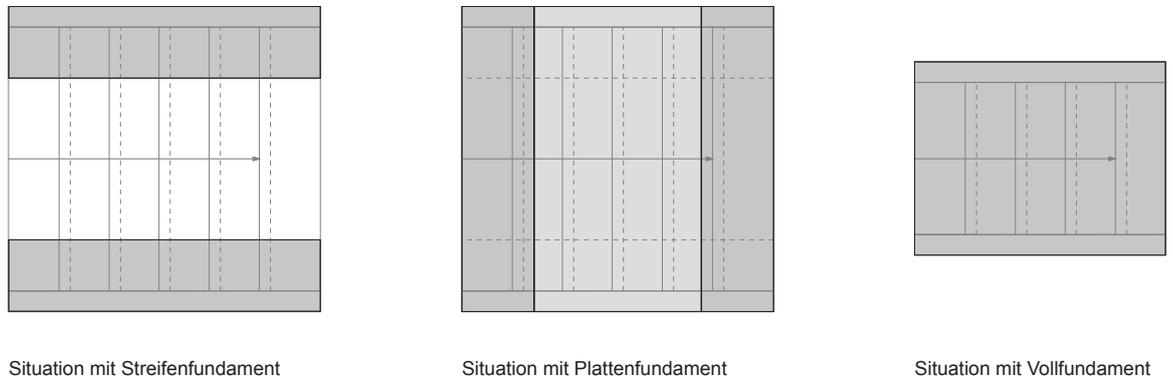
Grundriss-Schema: Fundamenttypen
